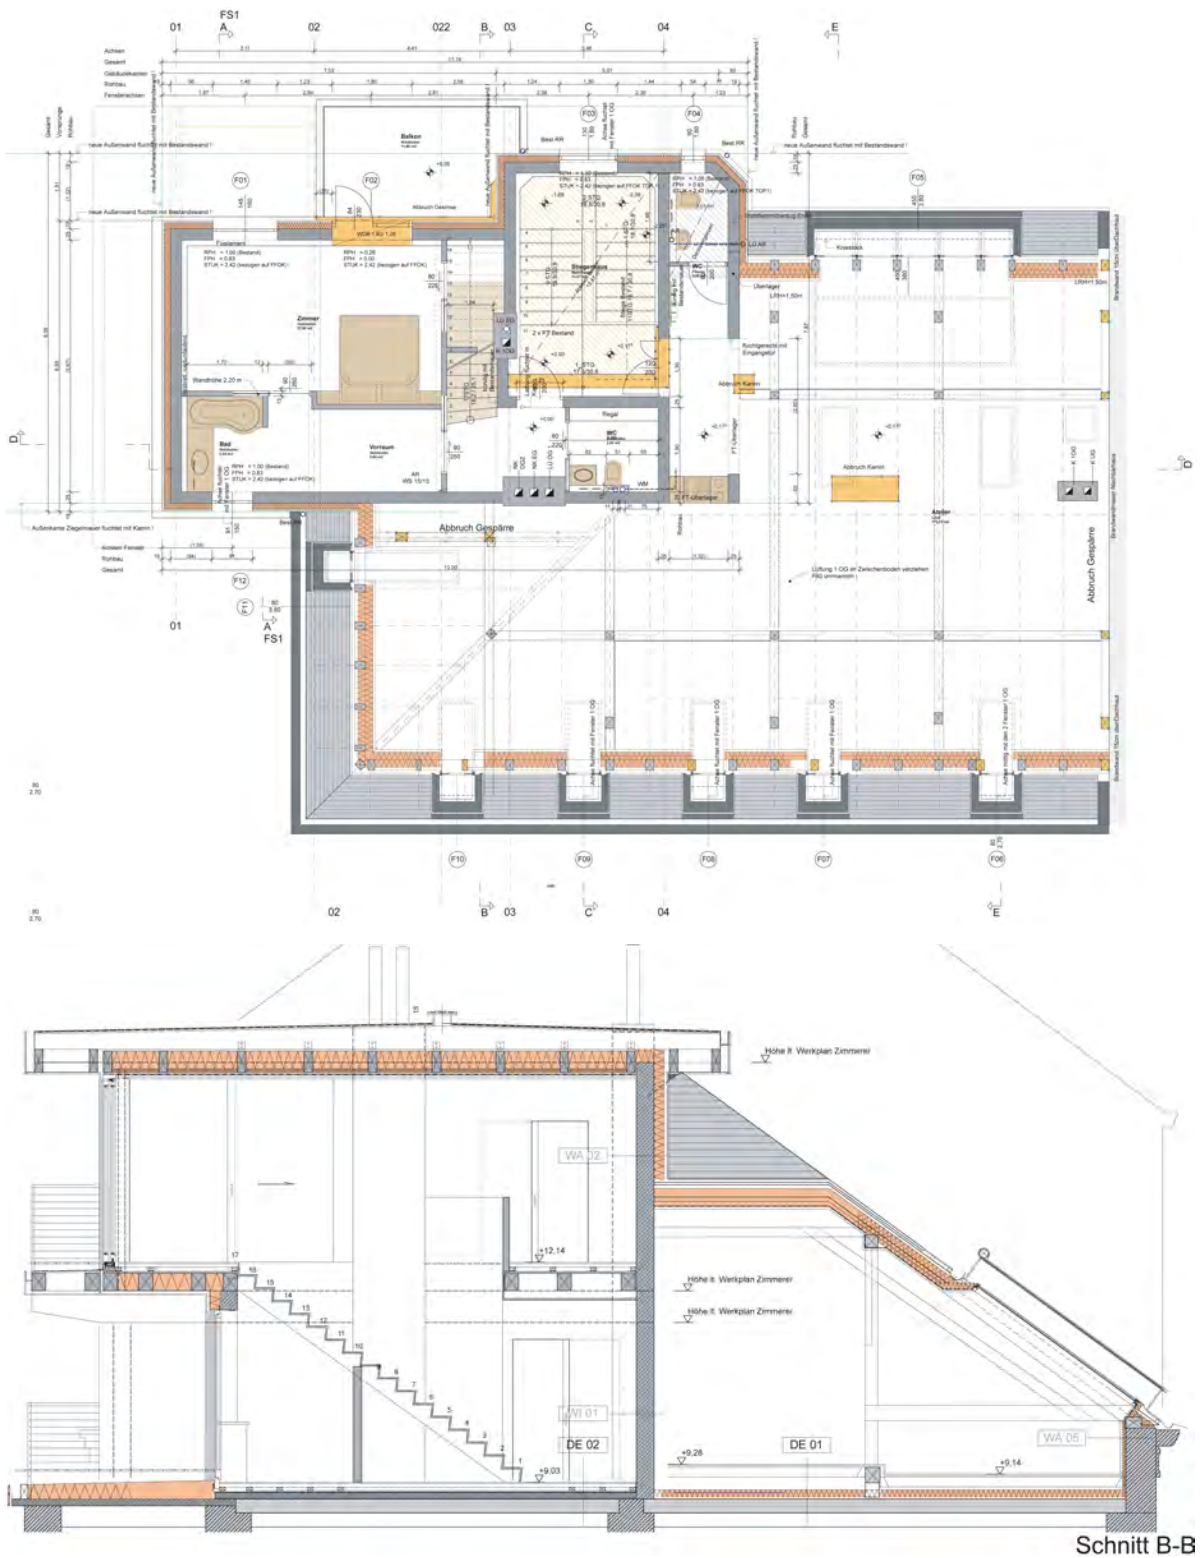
Grundriss Dachgeschoss 2 und Schnitt B-B
